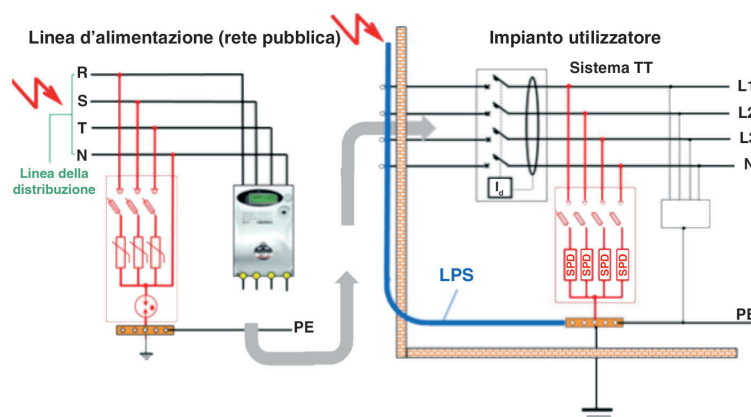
Applicazione congiunta delle Norme CEI 64-8, CEI EN 62305 e della Guida CEI 81-27
